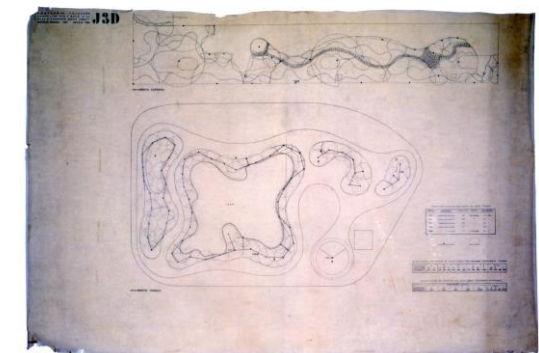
Proyecto original de la Plaza Senador Salgado Filho con los detalles del sistema de irrigación, posiblemente de 1947.
